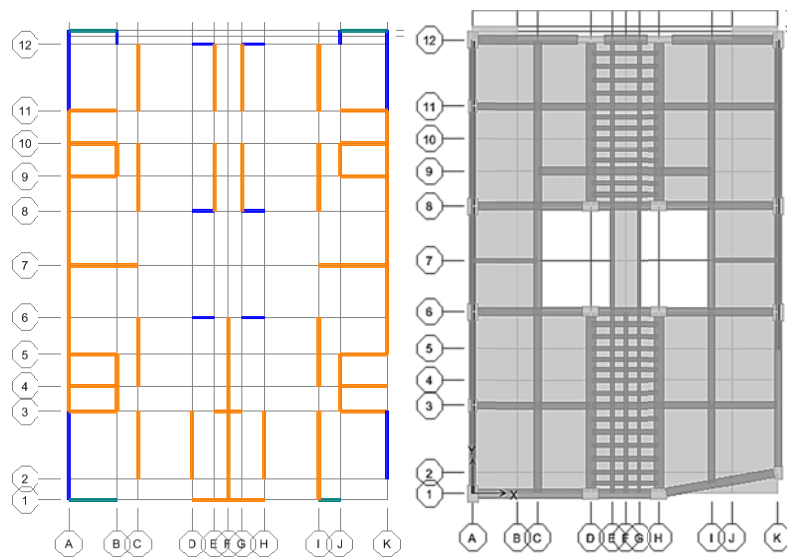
Izq.) Distribución de muros sobre losa de transferencia Edificio A, Der) Piso de Transferencia
